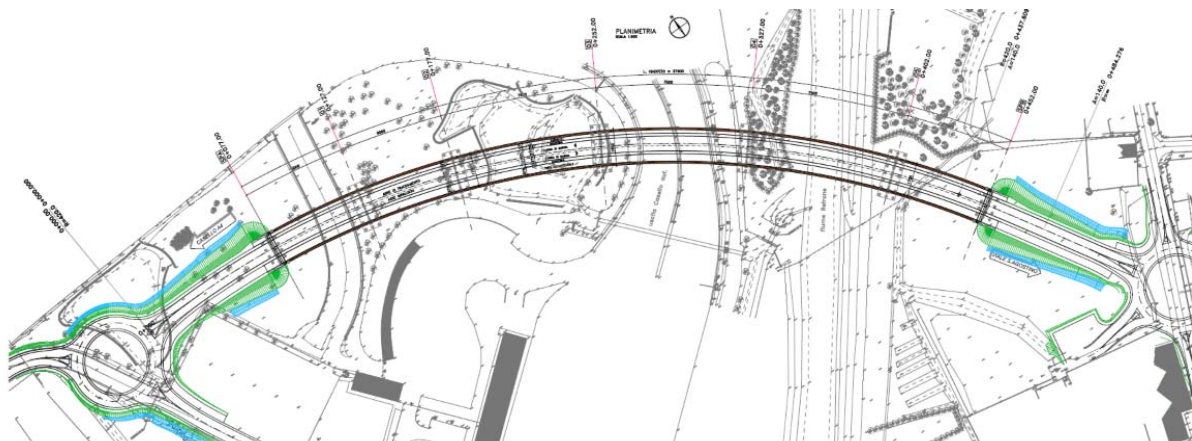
Ponte sul F. Retrone – Inquadratura planimetrica.
